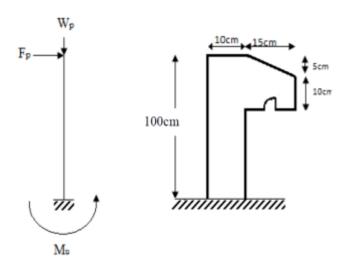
Dimension et schéma statique de l'acrotère.
